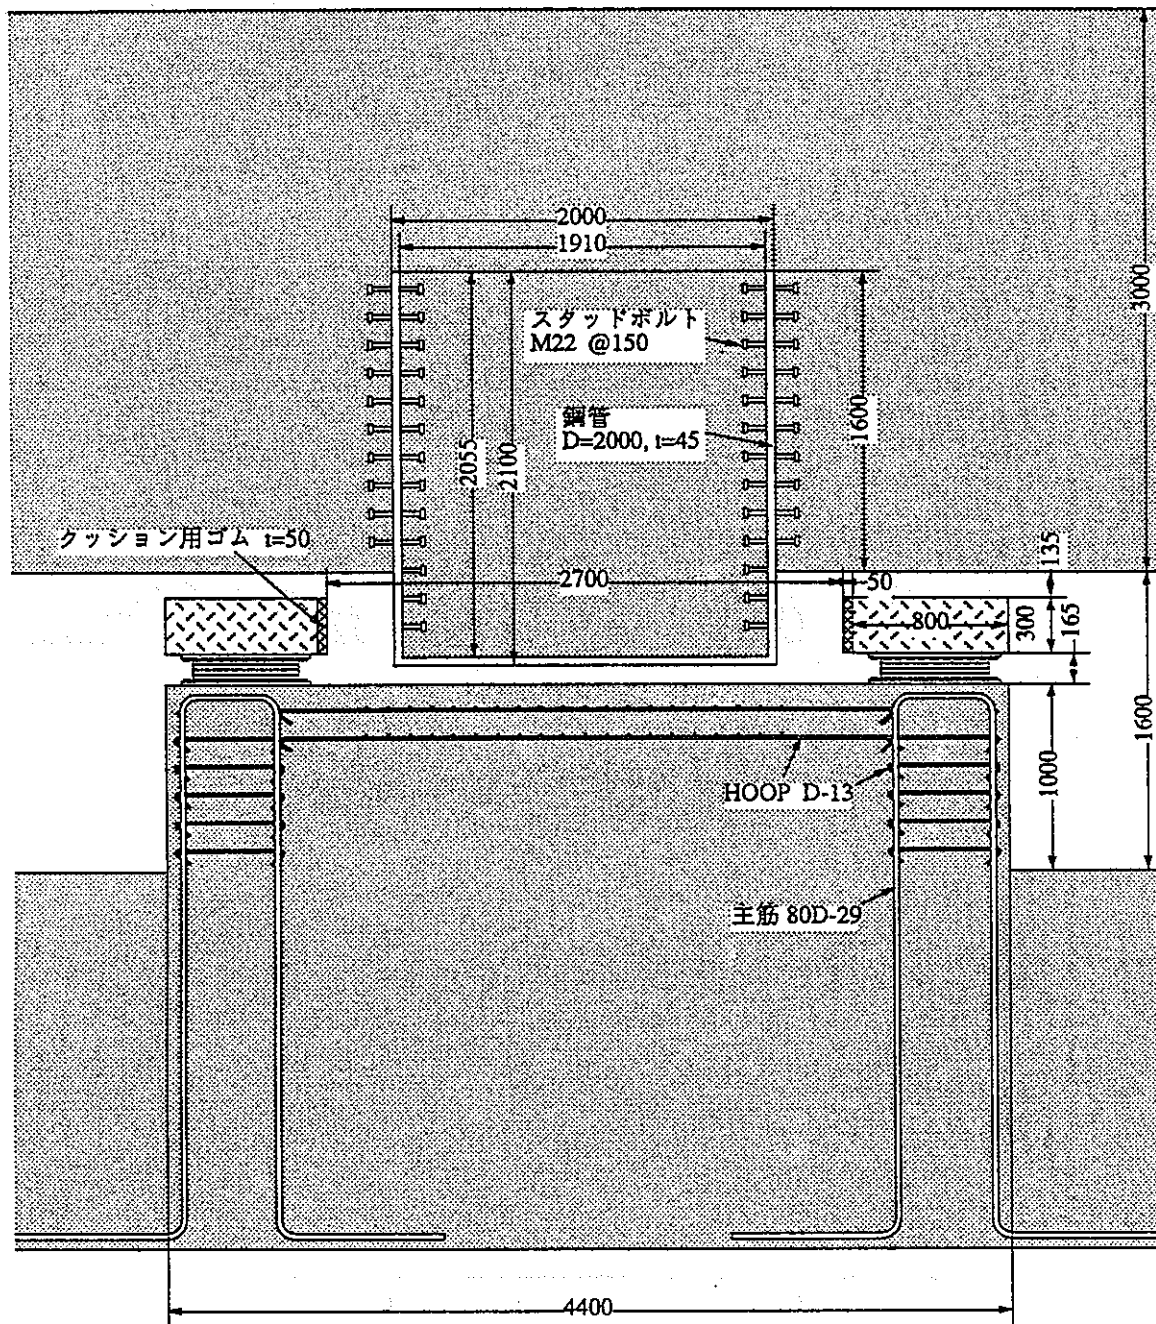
フェイルセーフ装置断面詳細図 (単位: mm)
